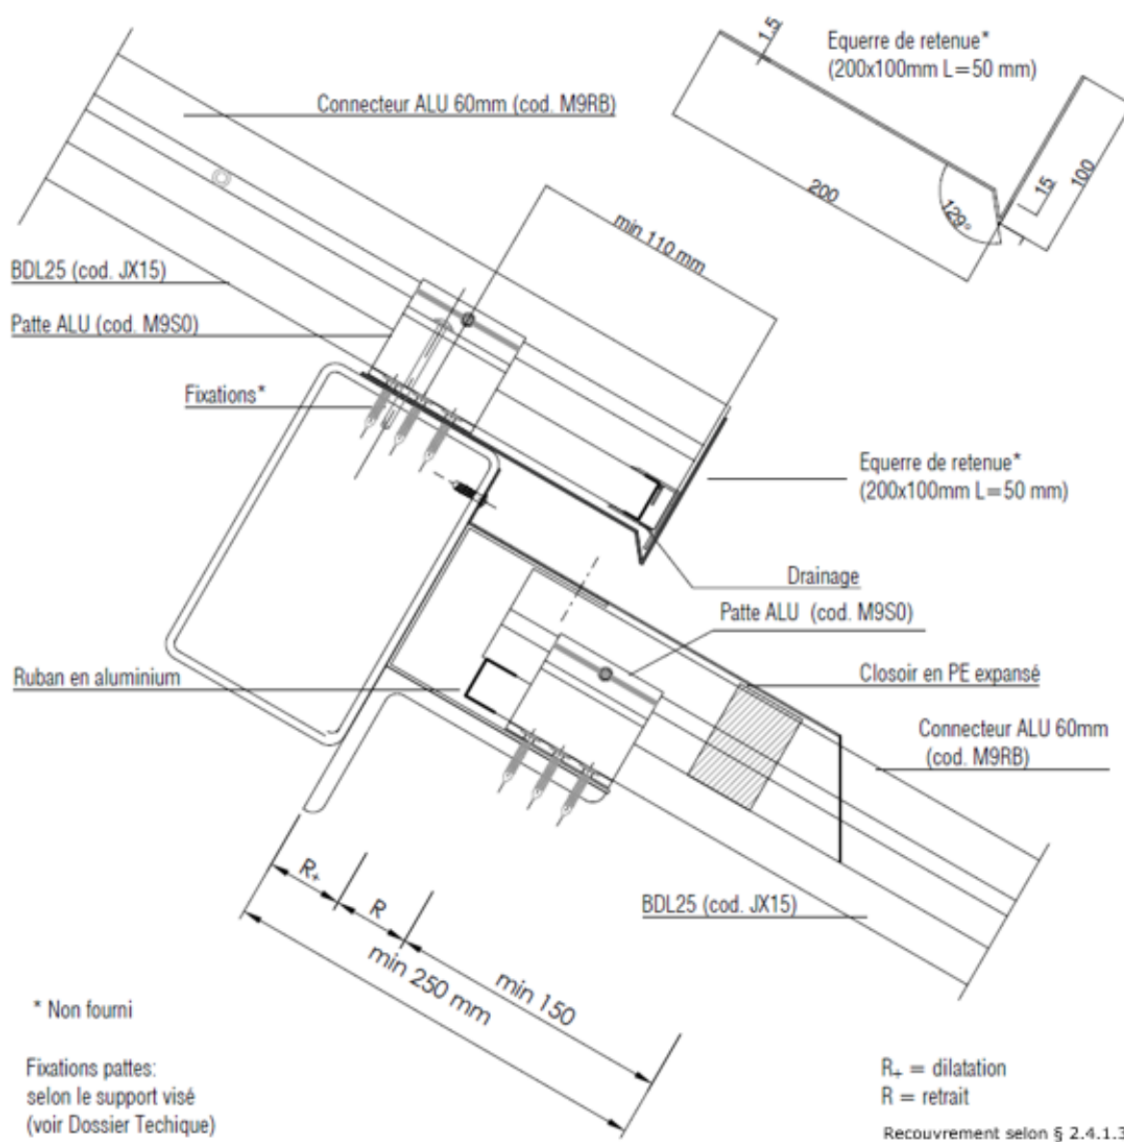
Ressaut avec point fixe bas et connecteur M9RB
